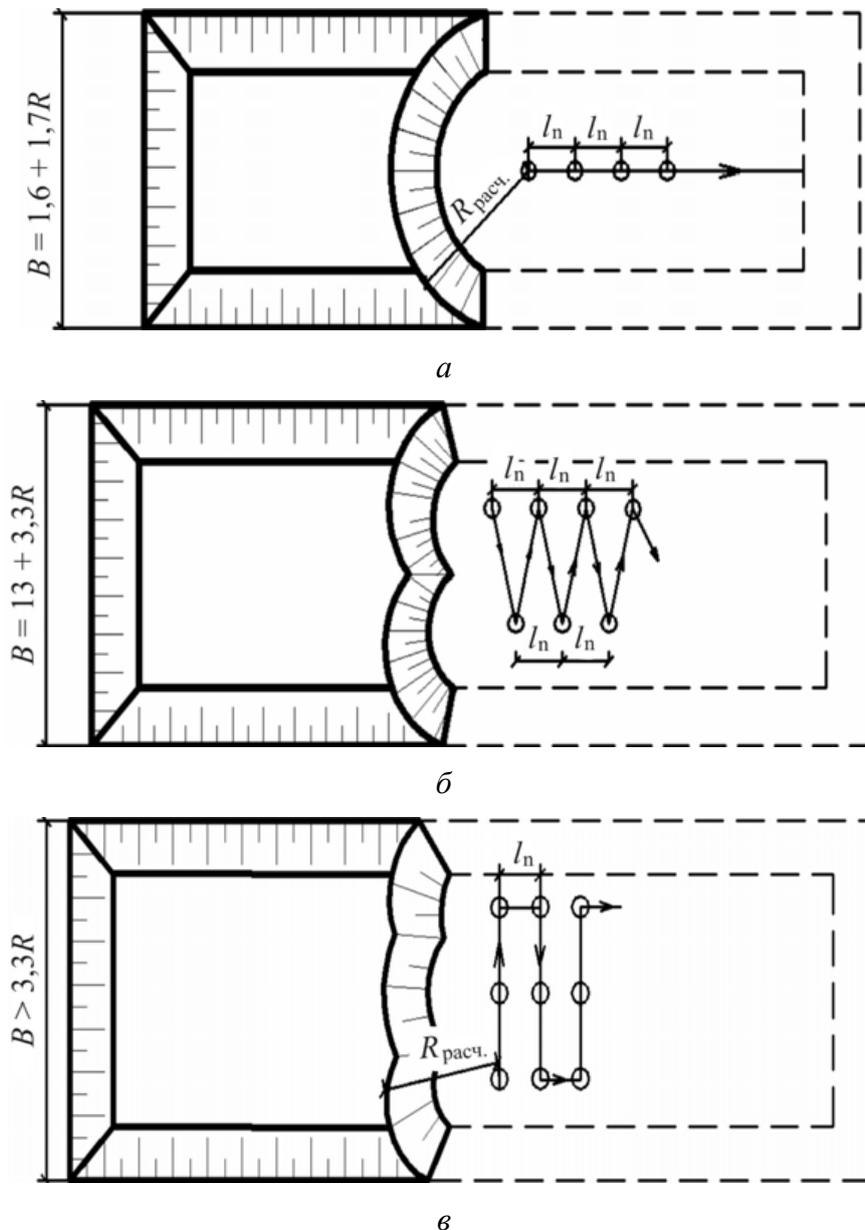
Схема разработки котлована торцевой проходкой с перемещением экскаватора, оборудованного обратной лопатой: а — вдоль котлована; б — зигзагом; в — поперек котлована
